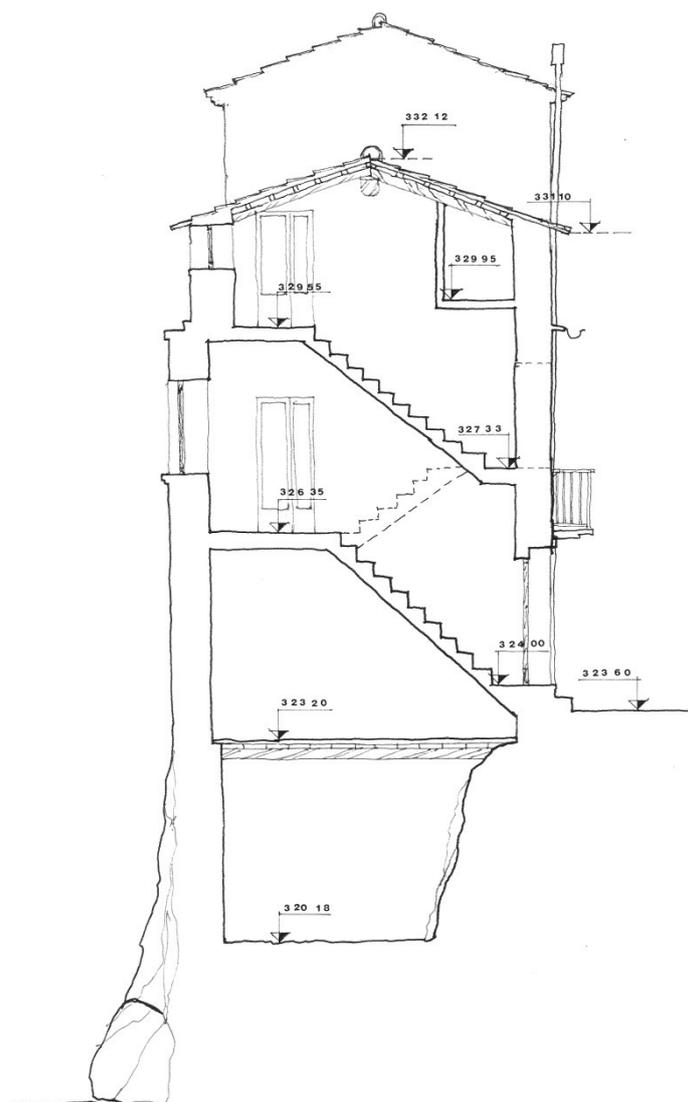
Rilievo del fabbricato esistente (Arch. Maurizio Castelli) / Sezione trasversale C-C
